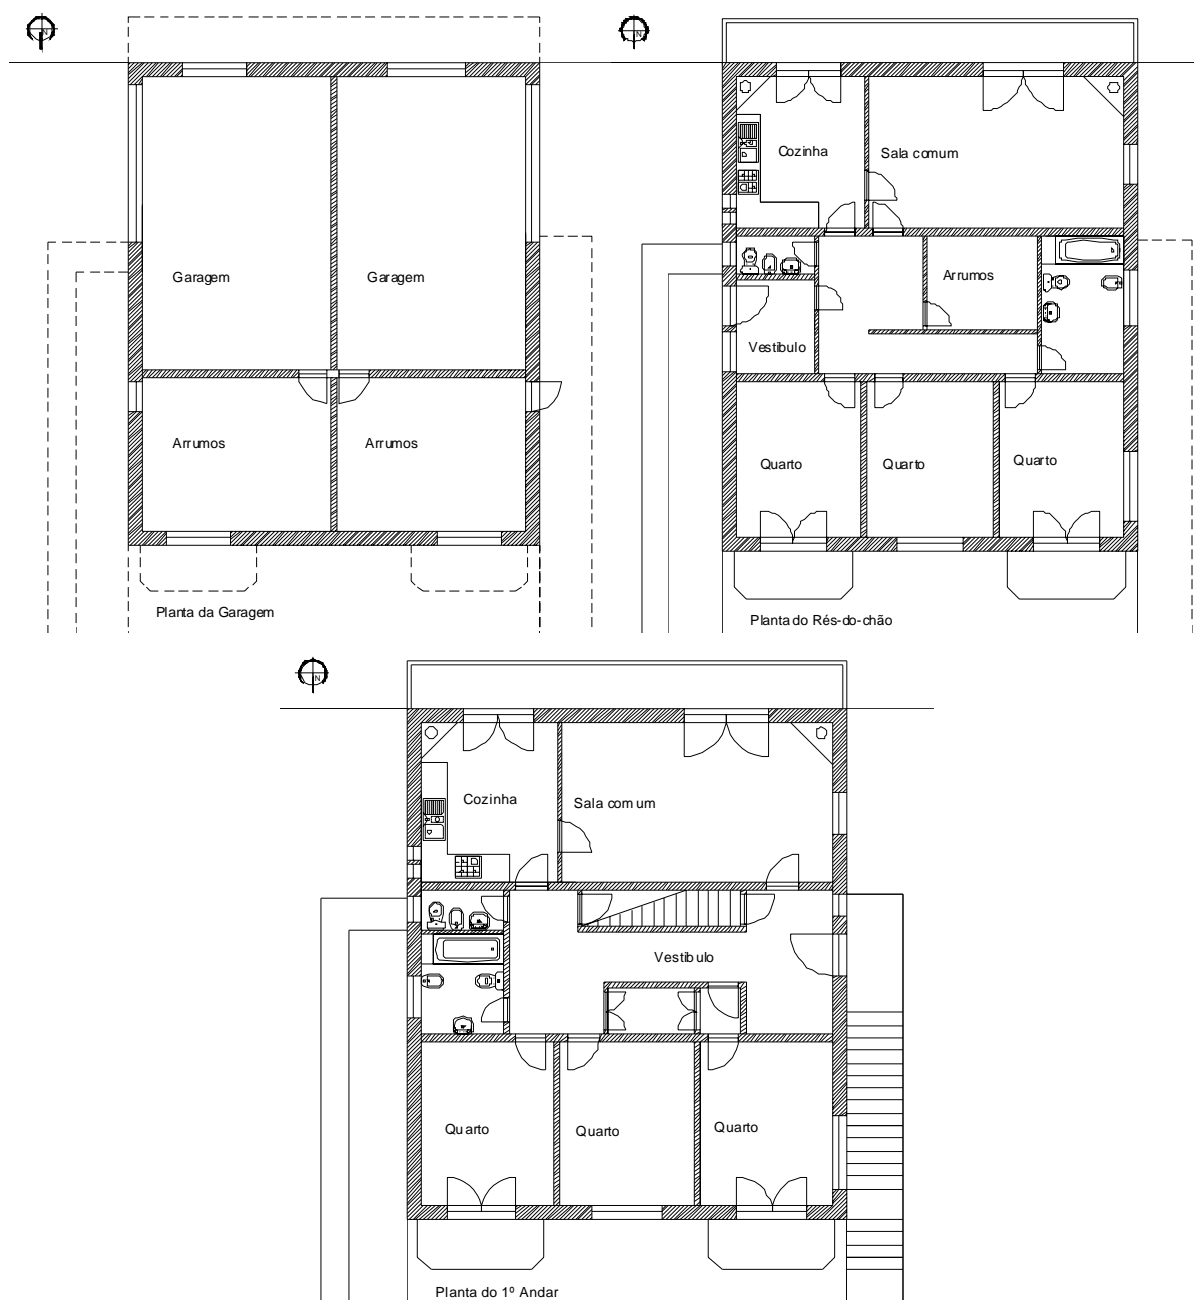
Planta da cave, R/C e 1º Andar do Edifício 8
